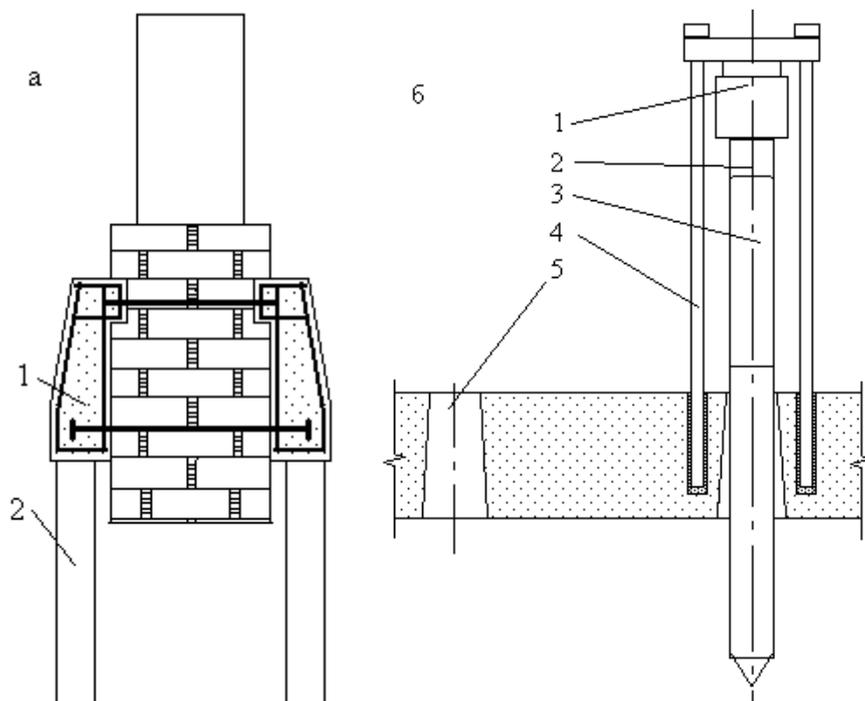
Усиление фундамента сваями: а – схема усиления; б – схема вдавливания сваи: 1 – гидравлический домкрат; 2 – сменный вкладыш; 3 – отрезок вдавливаемой трубы; 4 – анкерная тяга; 5 – отверстие в ростверке
